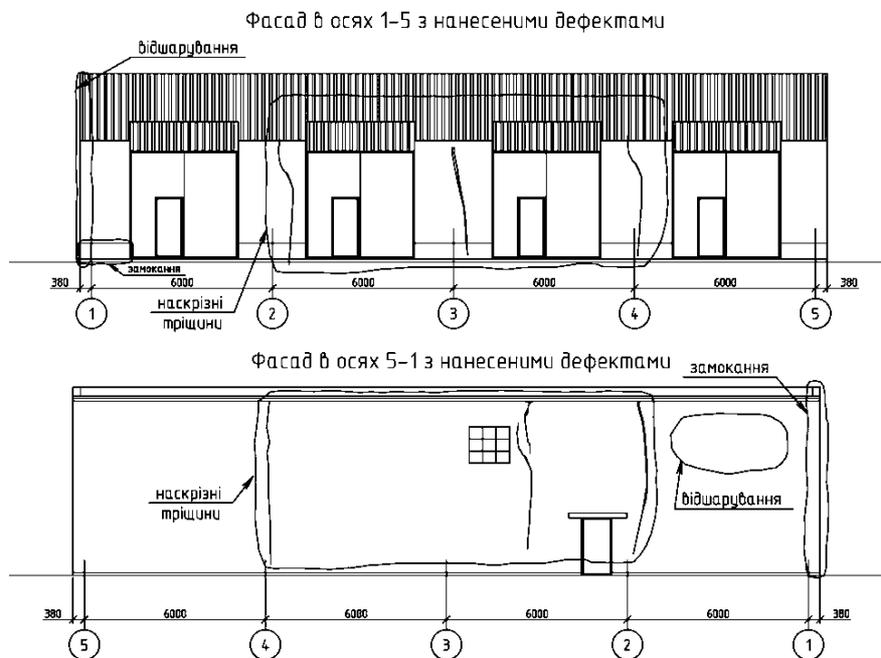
Фасади будівлі з нанесеними дефектами
